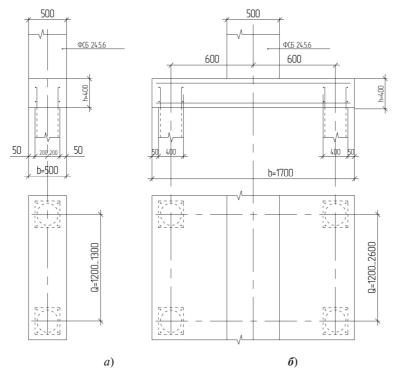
Свайные фундаменты с монолитным ростверком: a — размещение свай в один ряд;  $\delta$  — размещение свай в два ряда
